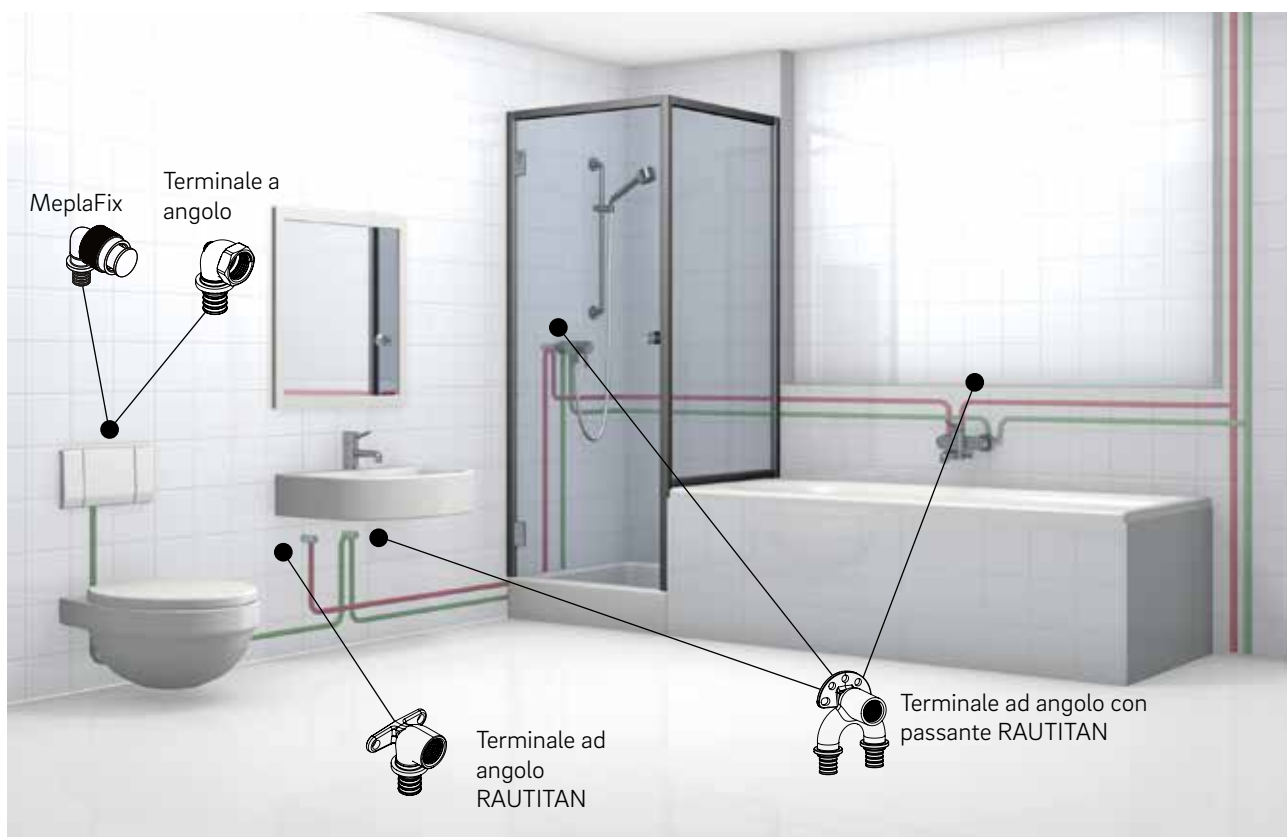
Installazione con collegamento in serie, con contenuto d'acqua < 3 lt. - Esempio bagno
